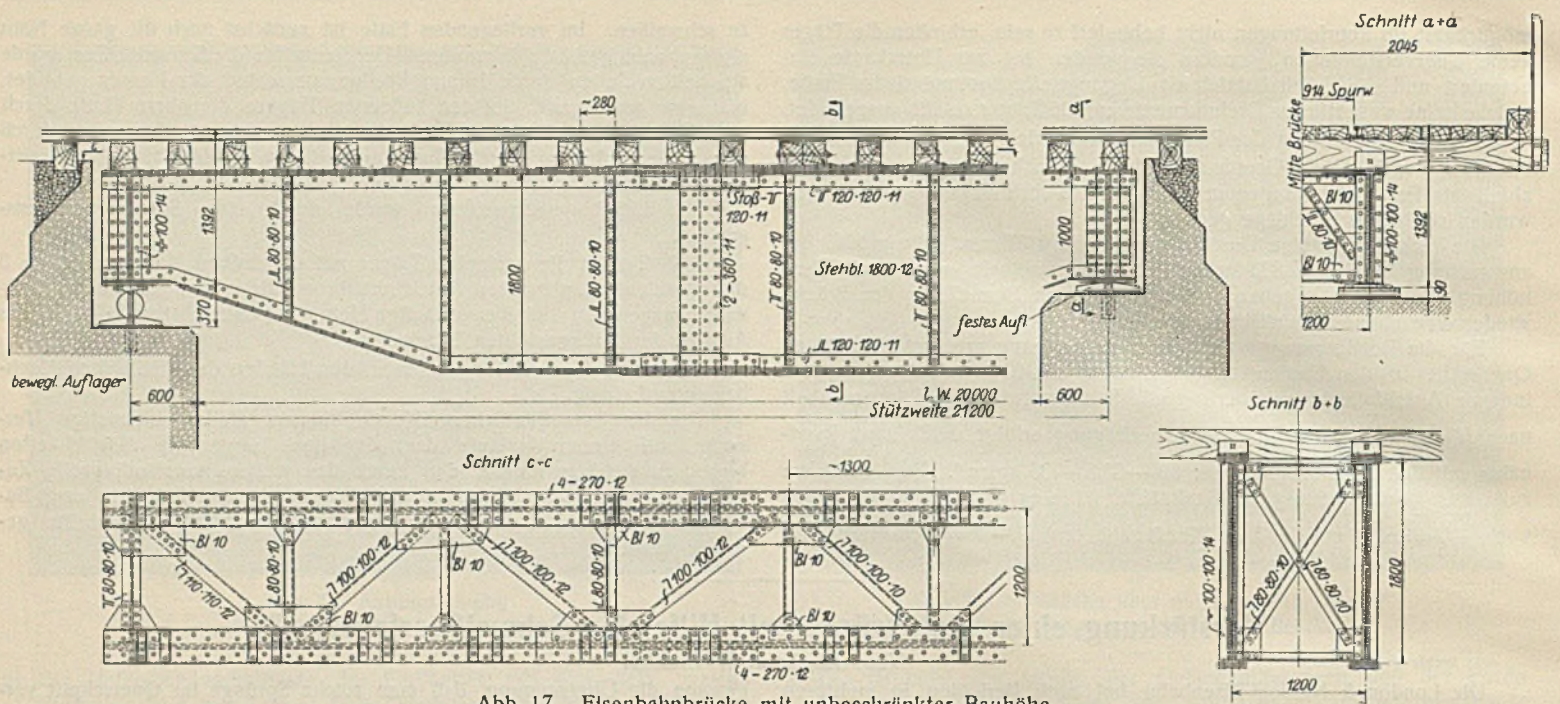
Eisenbahnbrücke mit unbeschränkter Bauhöhe.
